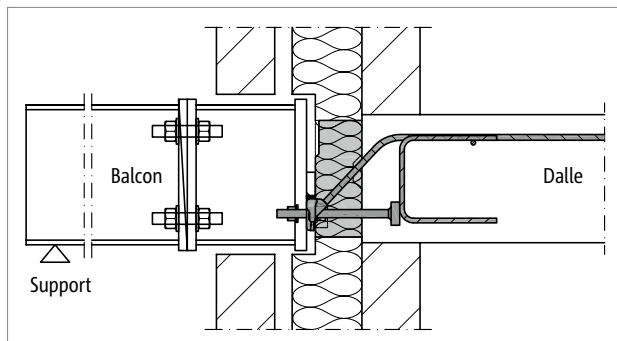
Schöck Isokorb® T type SQ : Corps isolant dans l'isolation du noyau ; la pièce de liaison sur site entre l'élément Isokorb® et le balcon permet une certaine flexibilité dans le processus de construction
